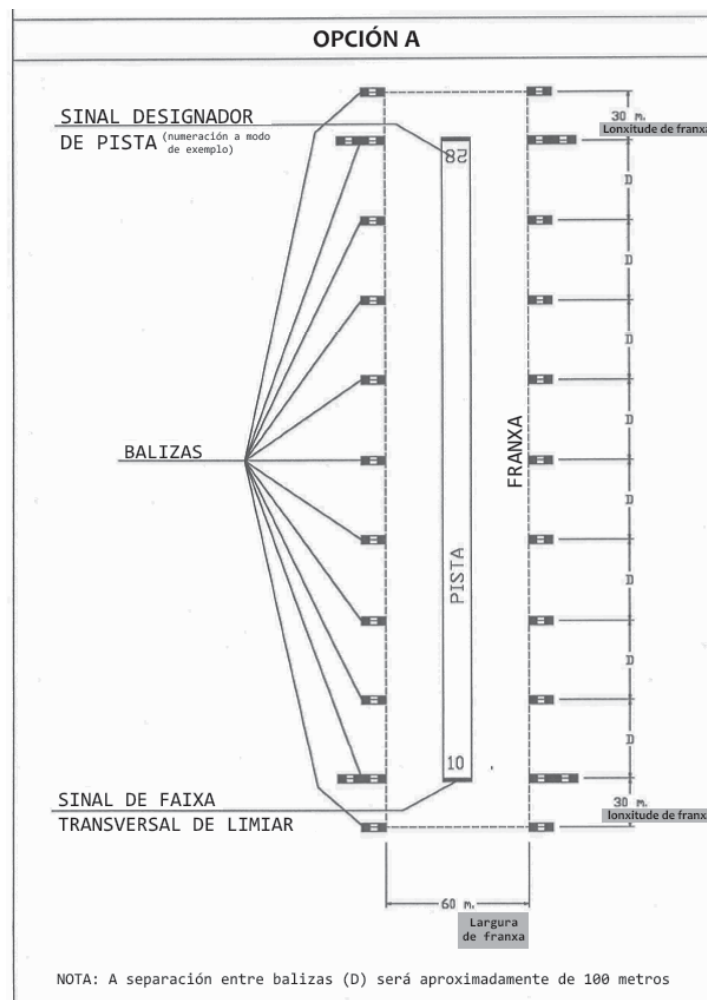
Sinalización de pistas non pavimentadas con limiar desprazado
